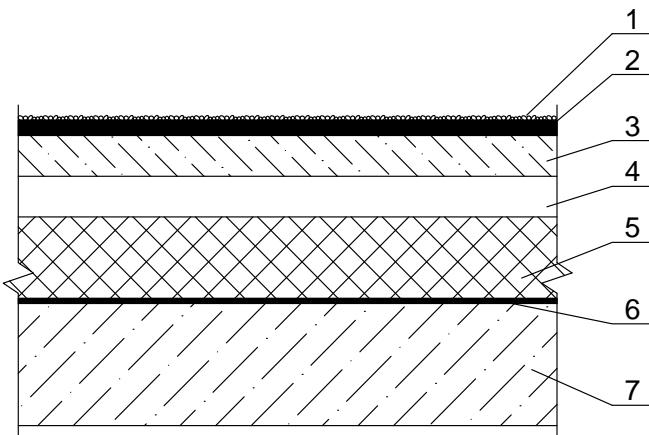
Вентилируемая (двухболочковая) кровля:
